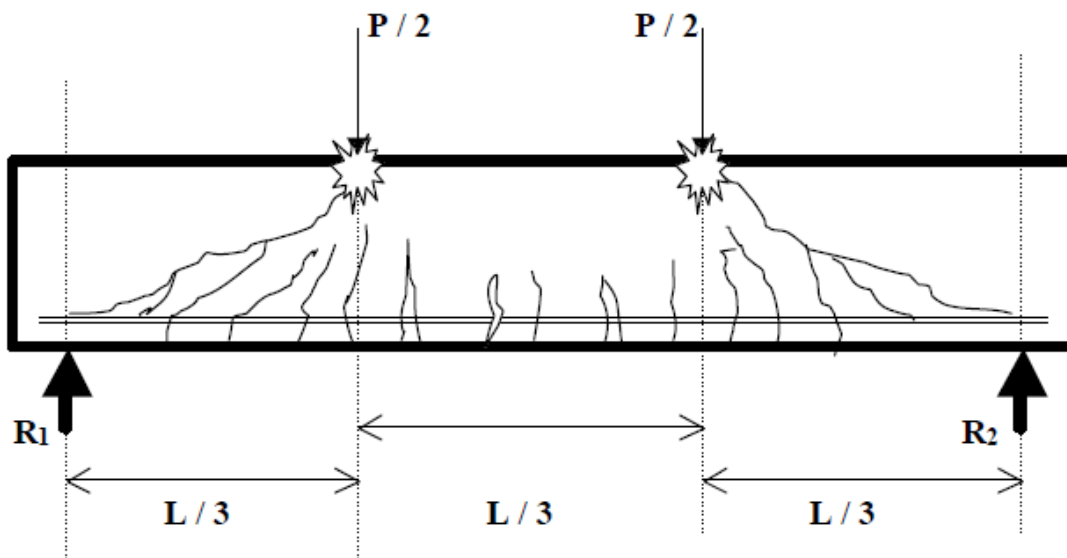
Falla típica a cortante en vigas simplemente apoyadas.
